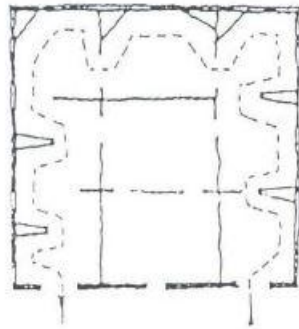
CENTRAL ARRANGEMENT
